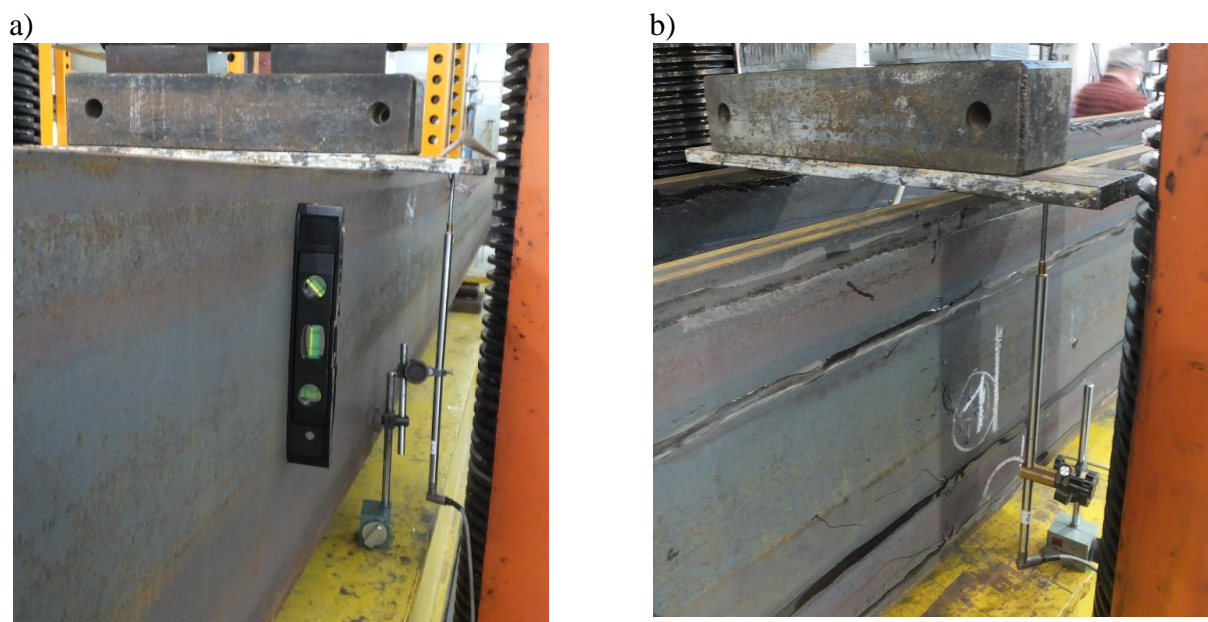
Widok elementu z naklejonymi tensometrami
